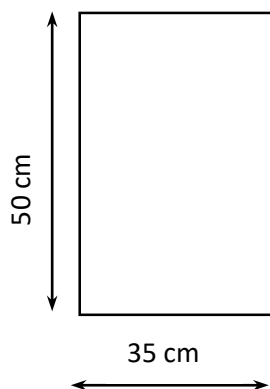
Pré-dimensionnement de la poutre palière (les escaliers de 2 volées)
